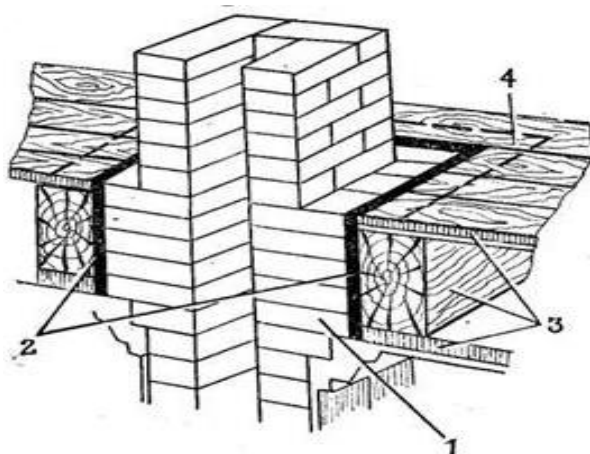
Схема влаштування горизонтальної протипожежної переділки в міжповерховому перекритті: 1 – переділка; 2 – ізоляція з азбесту або повсті, вимоченої в глиняному розчині; 3 – горюче або важкогорюче перекриття; 4 – негорюча підлога
